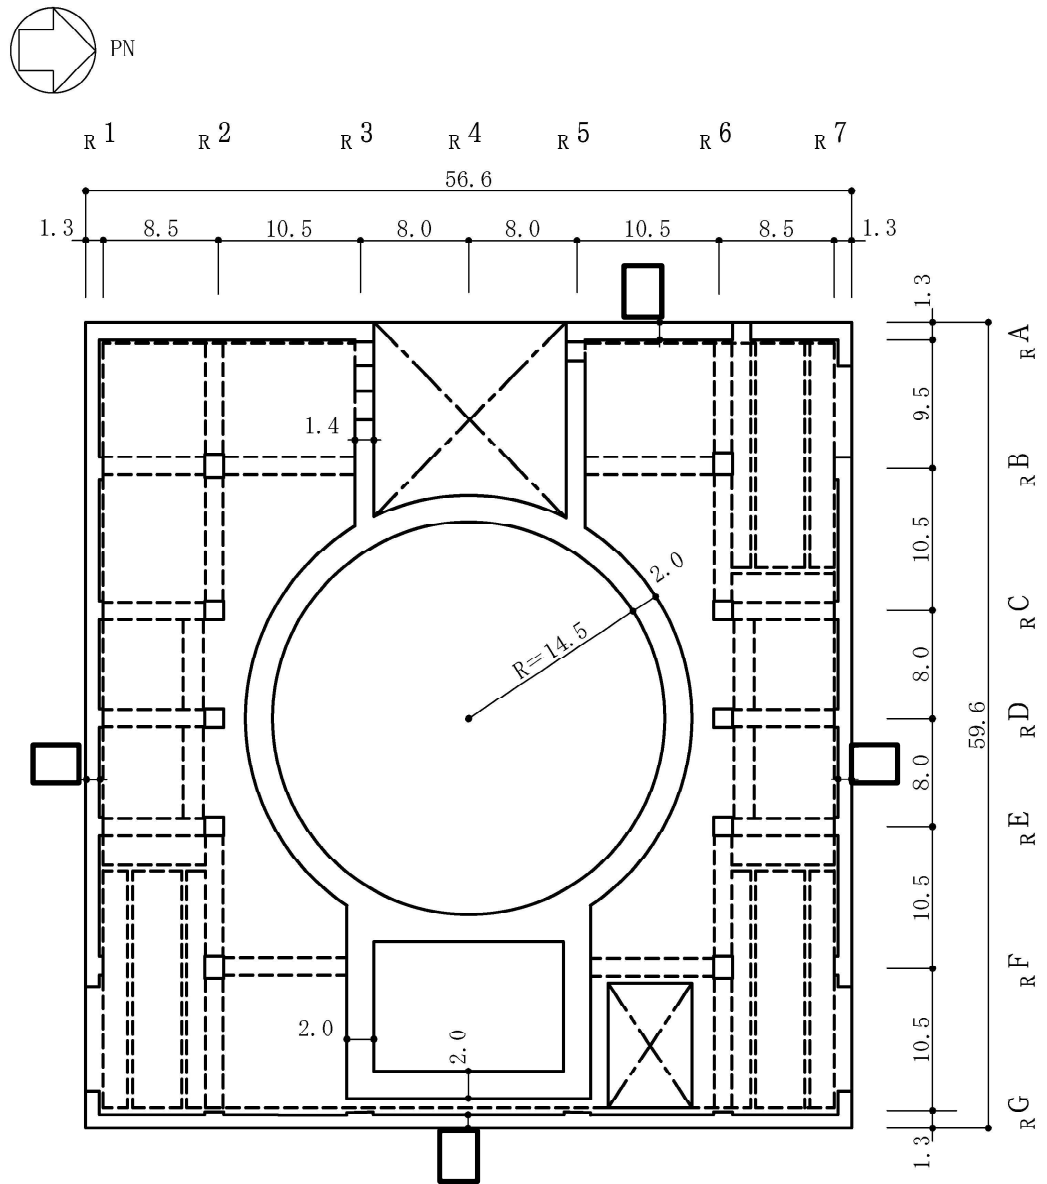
原子炉建屋の概略平面図 (2F, T.M.S.L. 18.1m) (5/9) (単位 : m)
